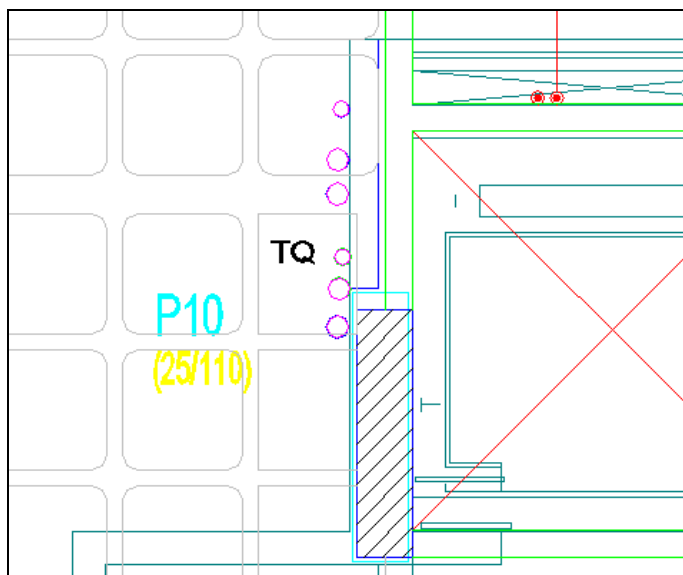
Shaft posicionado em local não previsto pelo projeto de estrutura
